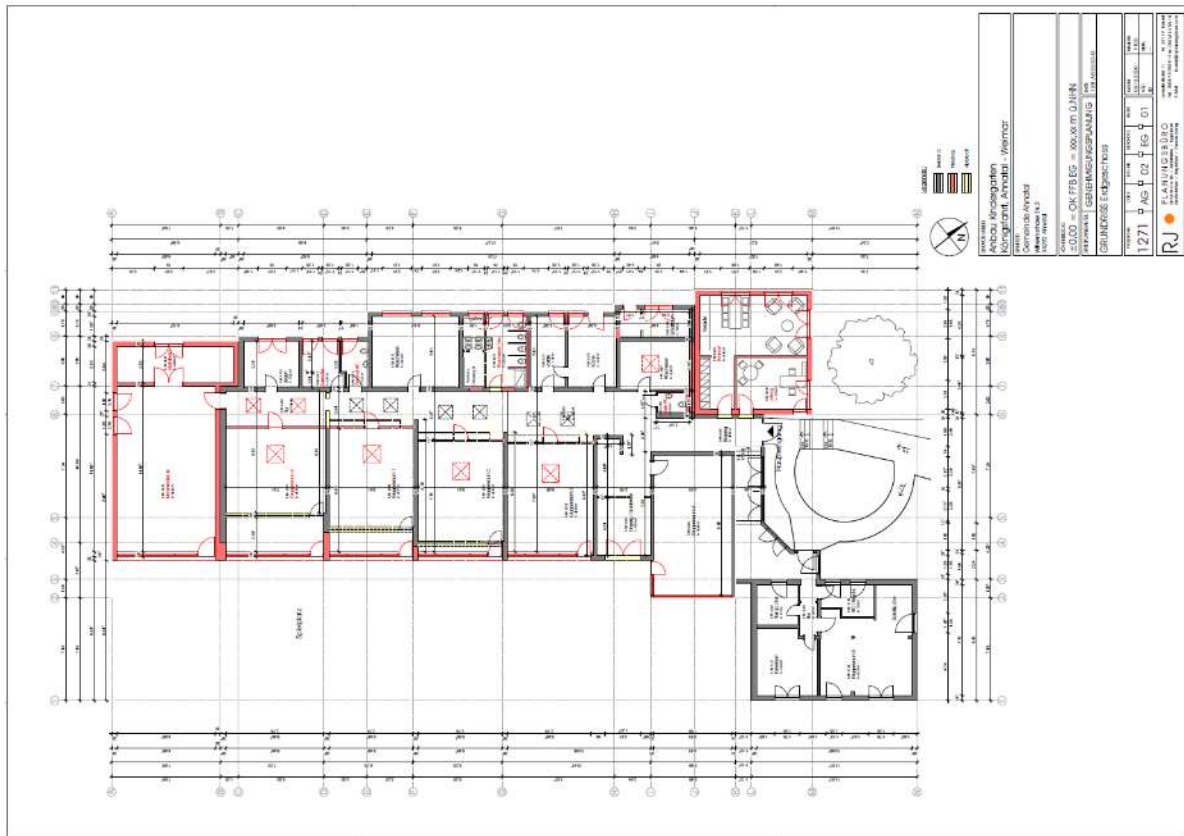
Grundrissplan mit Anbauten und ersetzten Bauteilen (rot)
